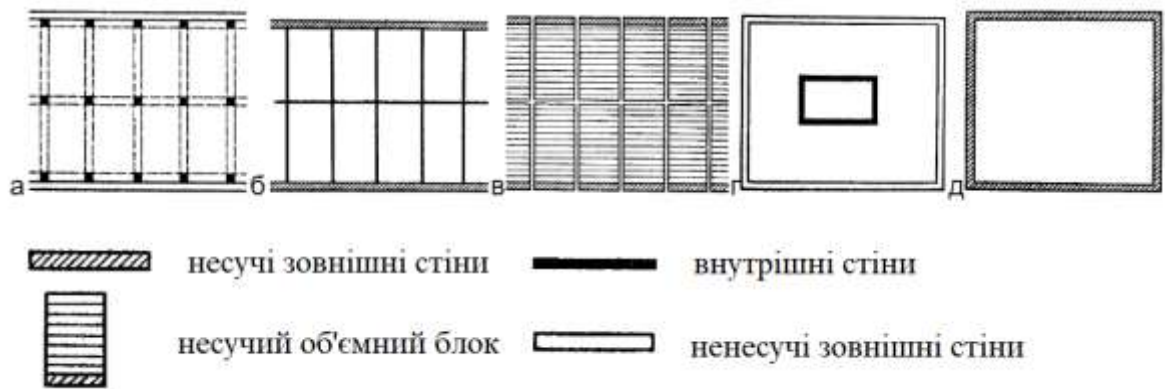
Основні конструктивні системи будівель: а – каркасна; б – безкаркасна; в – об'ємно-блокова (стовпчаста); г – стовбурна; д – оболонкова
